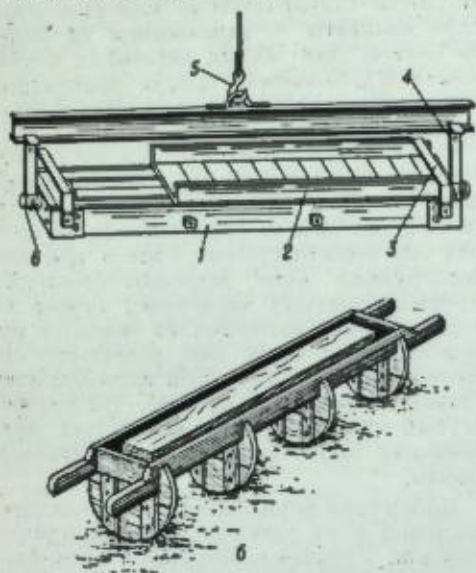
Опрокидные формы для мелких железобетонных изделий: а — на цапфах для выгрузки изделия на поддон; 1 — форма; 2 — поддон; 3 — шпоба; 4 — подвеска; 5 — крюк крана; 6 — цапфа; б — на кружалах для выгрузки изделия на поверхность стенца.
